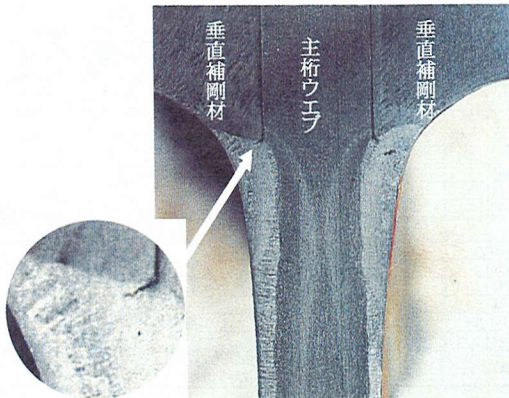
垂直補剛材下端回し溶接部マクロ
